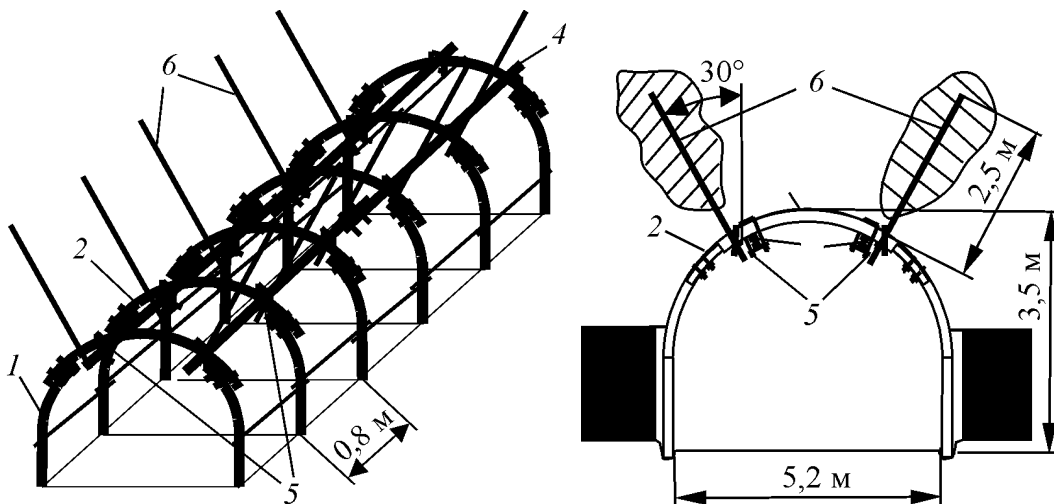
Конструкция двойной продольно-балочной усиливающей крепи: 1 – ножка крепи, 2 – верхняк; 3 – криволинейный сегмент из отрезка верхняка (СВП-27) 4 – продольная балка из двутавра №14; 5 – элементы крепления балки к верхняку крепи
